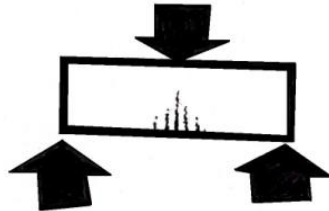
Detalle de pieza sometida a esfuerzo por flexión.
